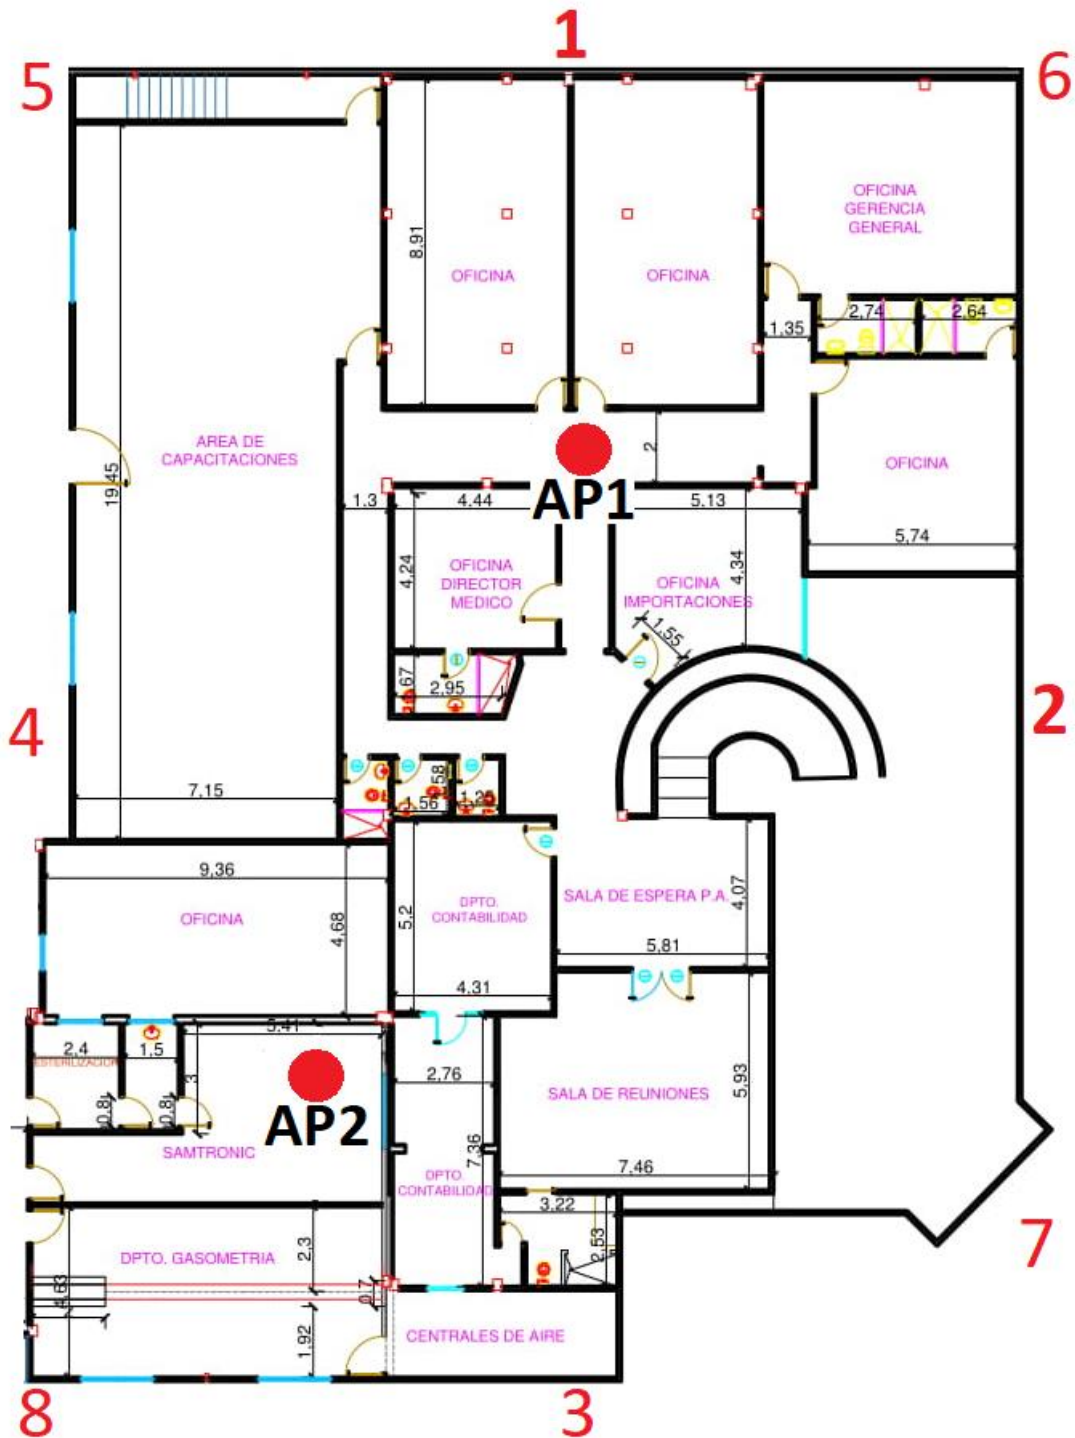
Ubicación de los AP en la planta alta, diseño 2
